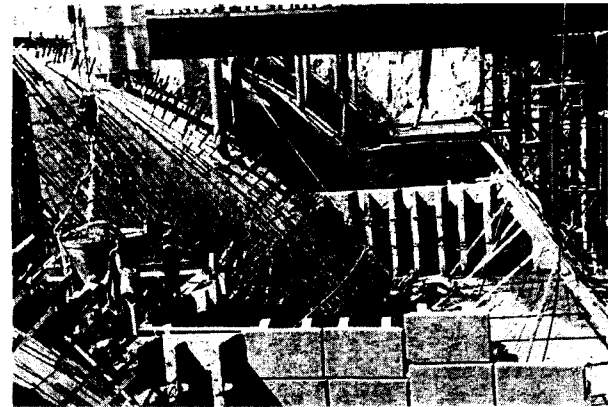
Бетонирование водоприемника плотины Бухтарминской ГЭС в опалубке из бетонных блоков кременчугского типа
